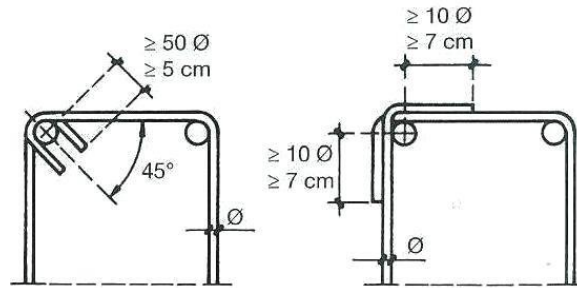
Gancho sísmico típico, usado en el diseño de estructuras de concreto armado.
